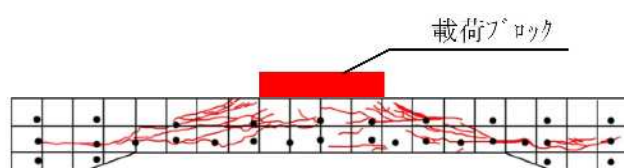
膨張材併用軽量 RC 床版のひび割れ図 (配力筋切断面)
